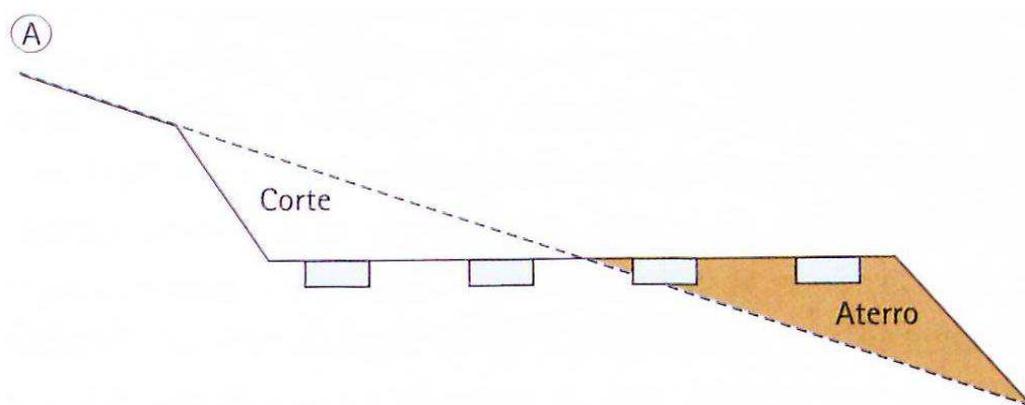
A) Exemplo de escavação para posterior aterro para implantação de fundações a mesma cota (Schnaid et al.,2005).
